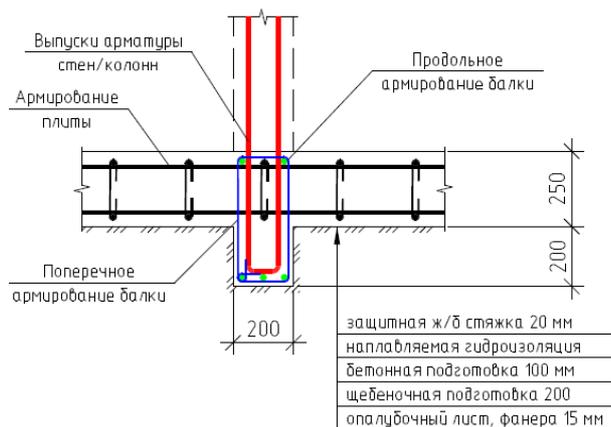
Конструкция ортотропной фундаментной плиты в разрезе
